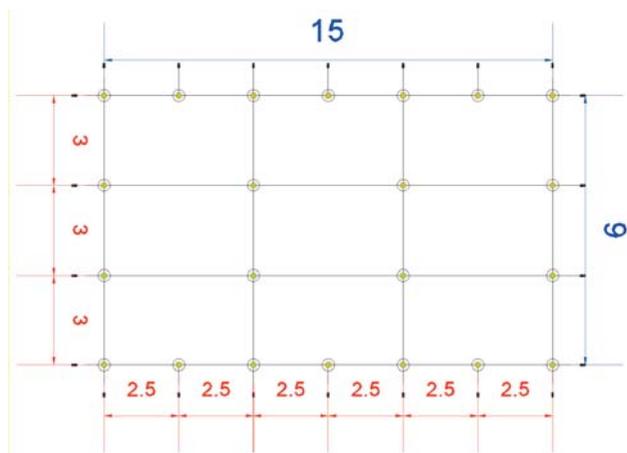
Vista Planta superior de la estructura de soporte. Diseño CREDyCOM
